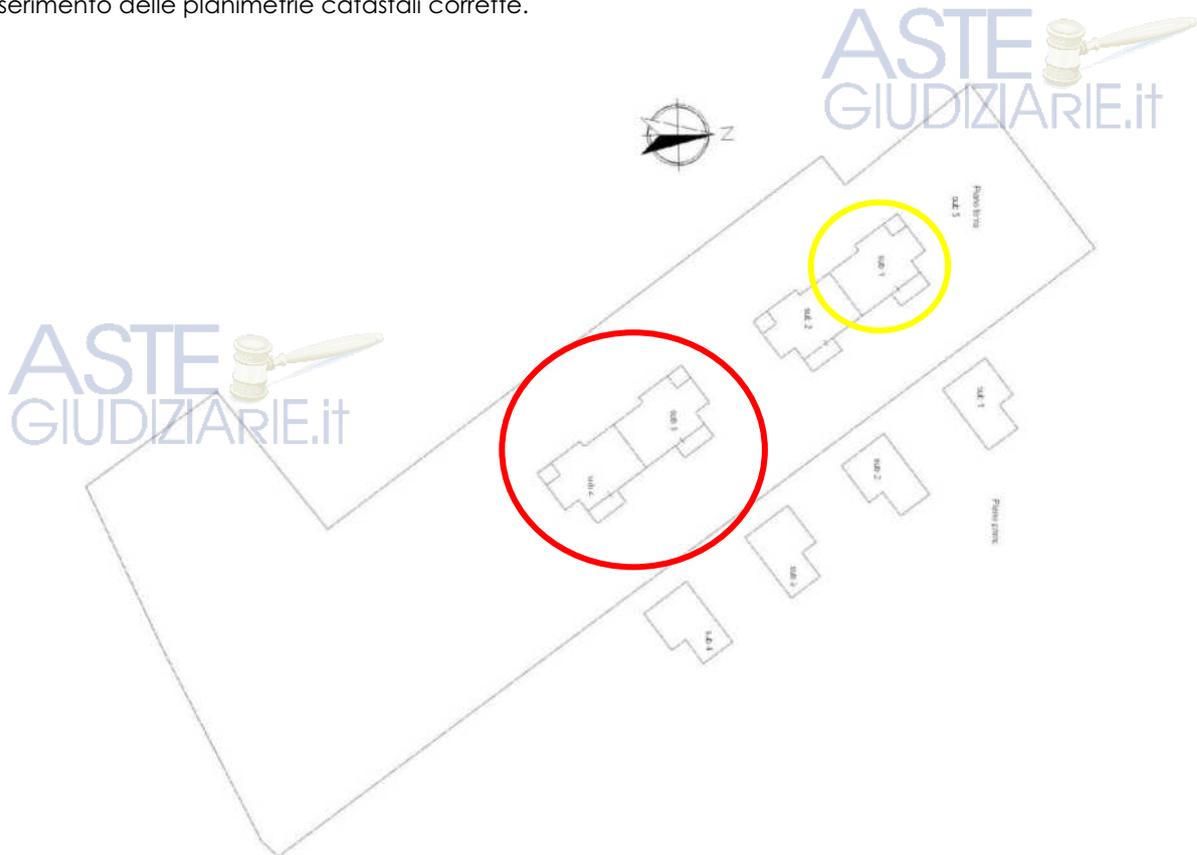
Elaborato planimetrico redatto in sede di accatastamento (25.01.2022). Foglio 75 Particella 658.
